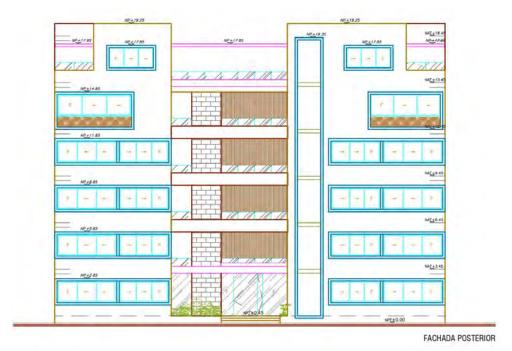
Plano del lado Sur de la fachada posterior del proyecto.
